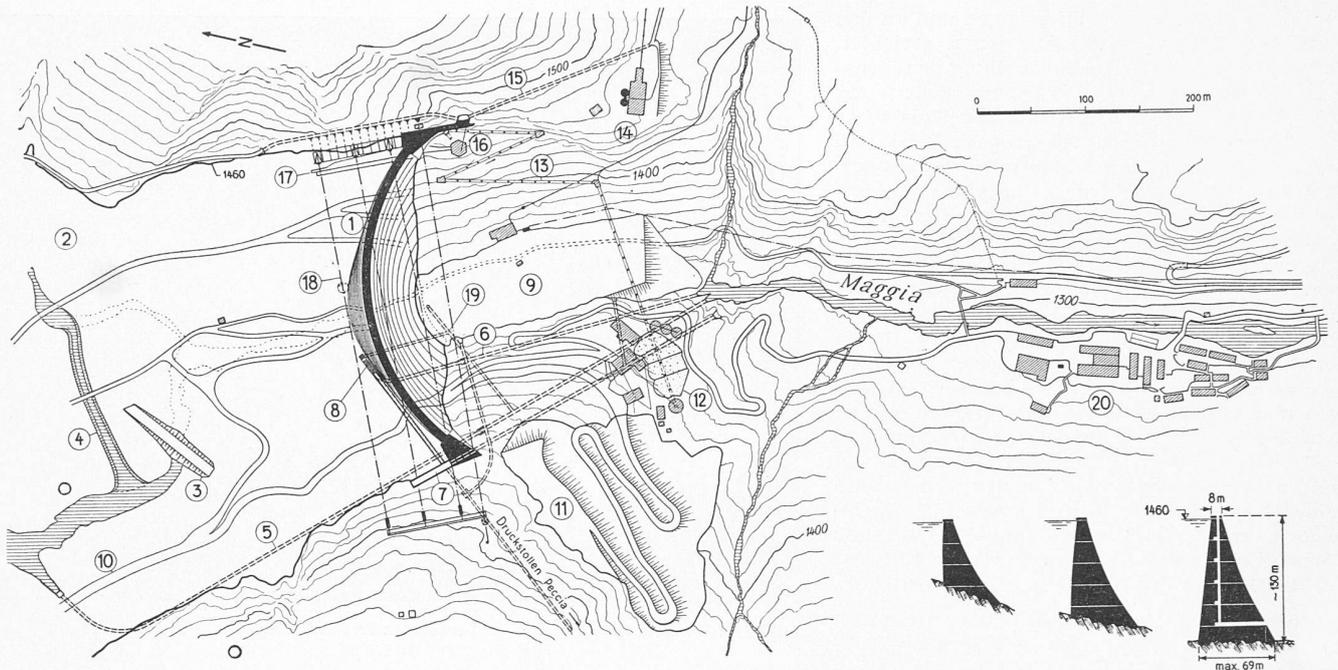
Staumauer Sambuco, Lageplan und Schnitte 1:7000
